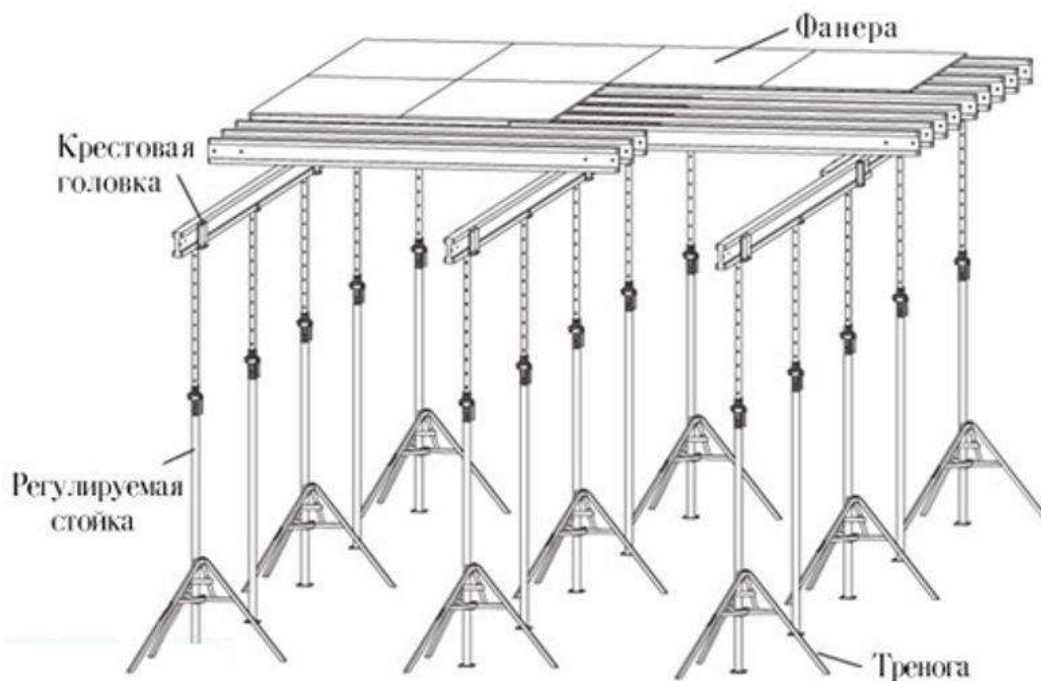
Схема установки опалубки для бетонирования перекрытия.
